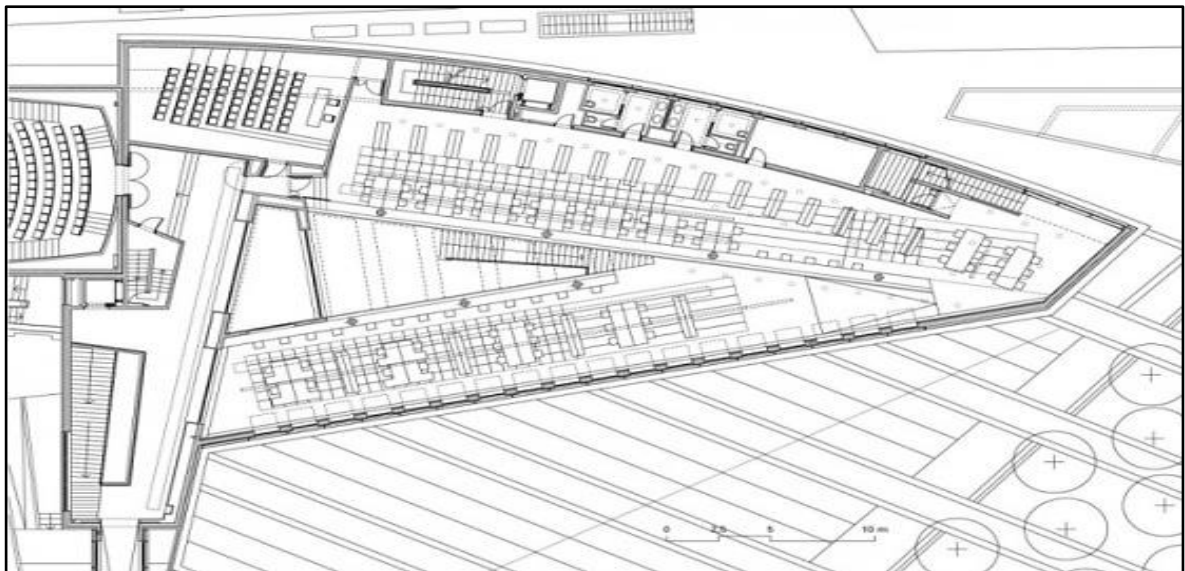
Planta centro cultural Bafile. (Fuente: Estrategias Ambientales Puerto Vilelas)
